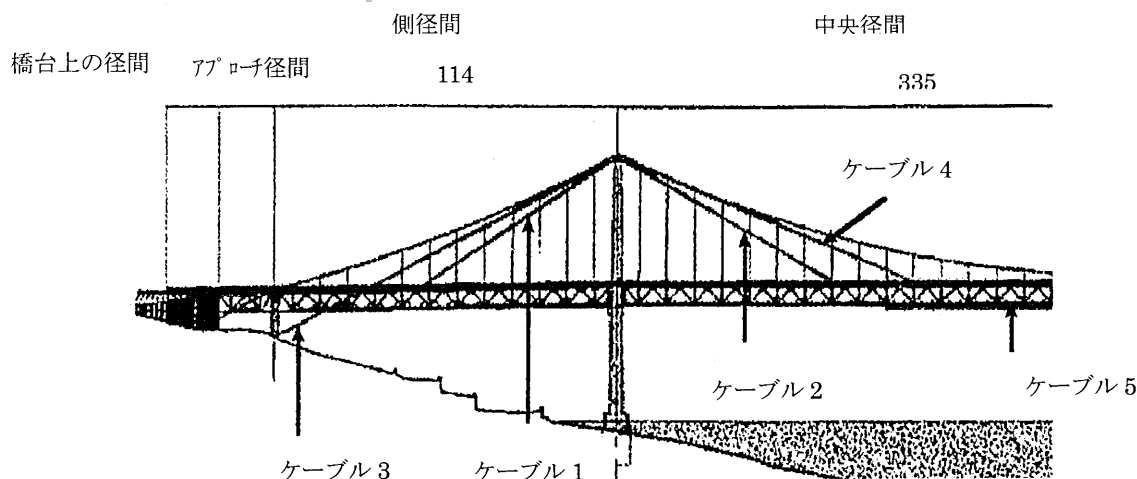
タマー橋の補強概要図(寸法単位: m)
